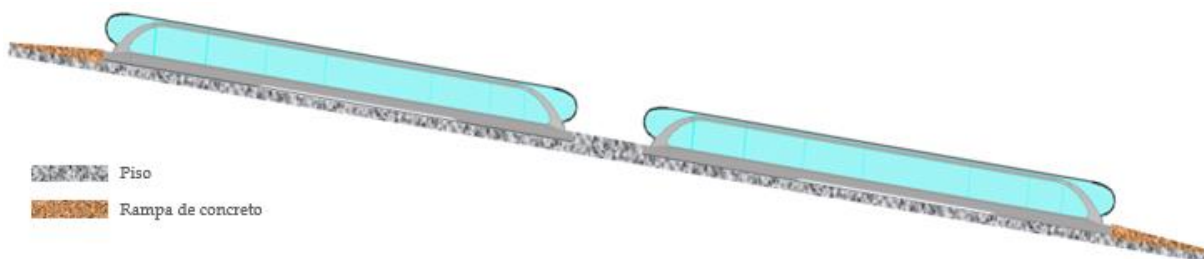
Layout das esteiras rolantes e rampas de concreto
